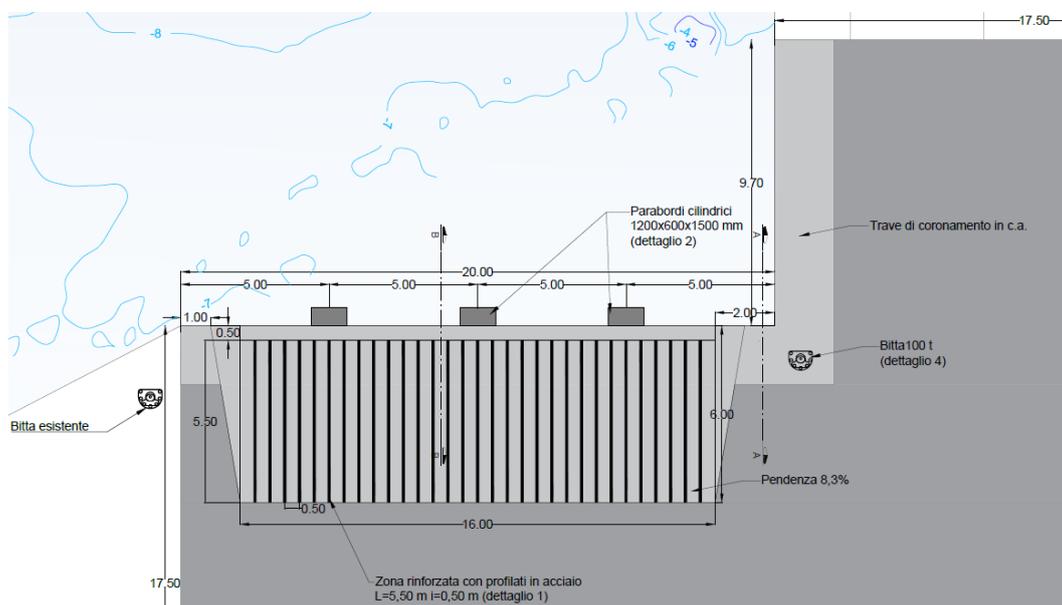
Planimetria arredi portuali – intervento di consolidamento radice ovest del molo
